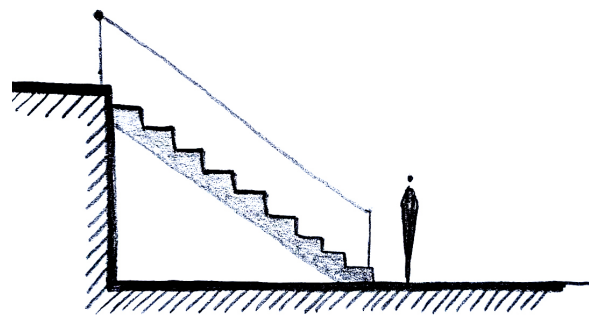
Boceto explicativo de conexiones transversales. Fuente: Elaboración propia.(2022)
